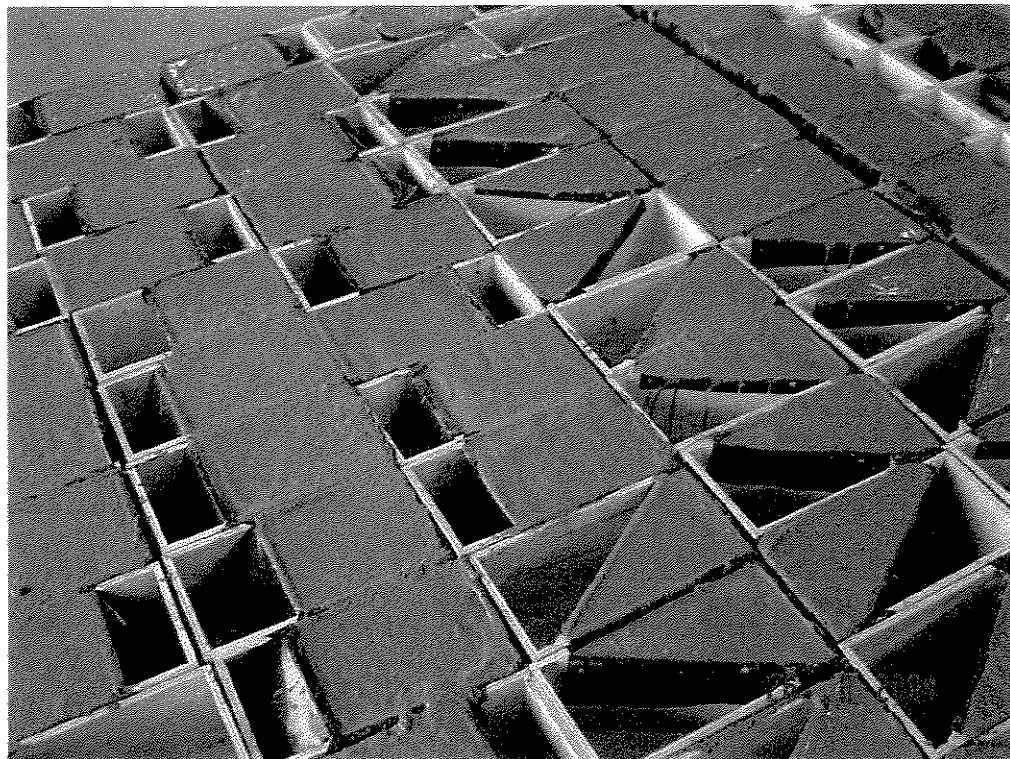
Fôrmas com somente um dos lados concretado.
